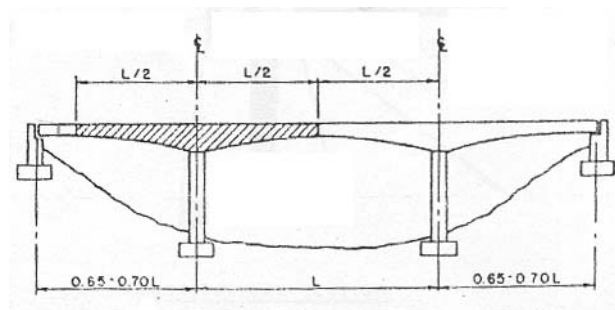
Distribuzione delle campate in corrispondenza della spalla.
